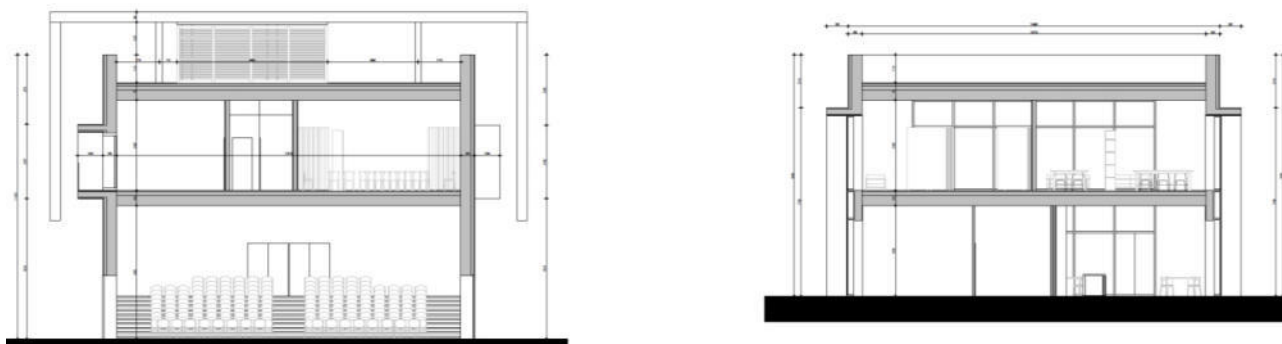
Sezioni trasversali A e B dell'edificio.
